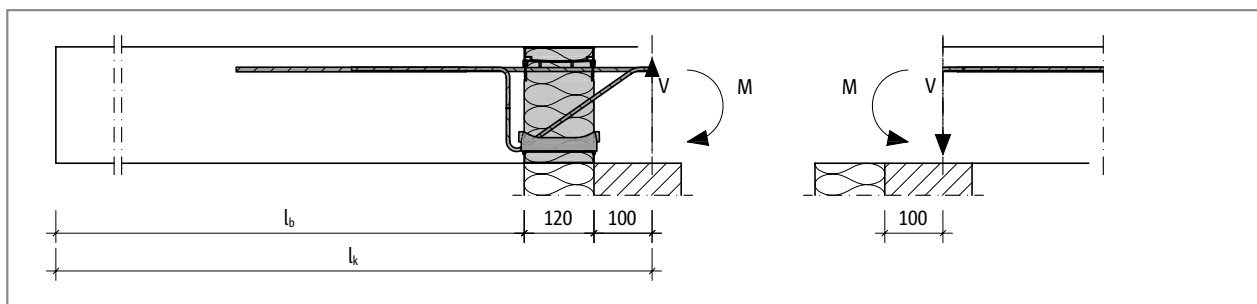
Schöck Isokorb® tipo KXT: dimensioni di sezione calcolate applicate al solaio
